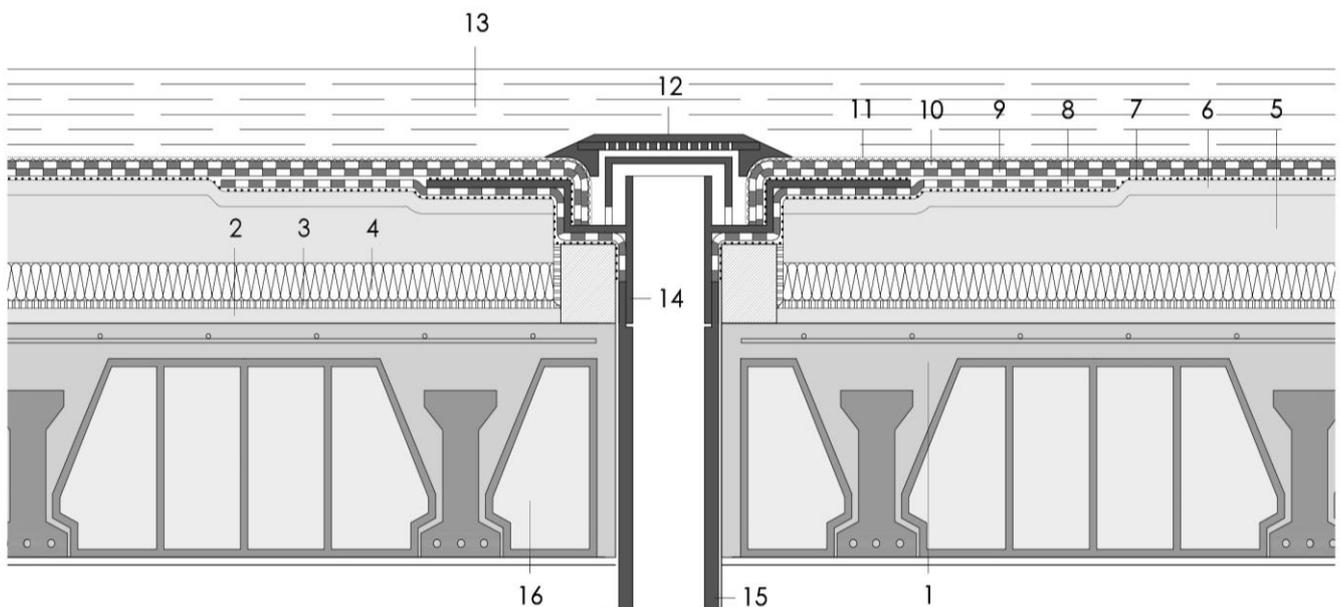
Sección constructiva por sumidero. E: 1/10
